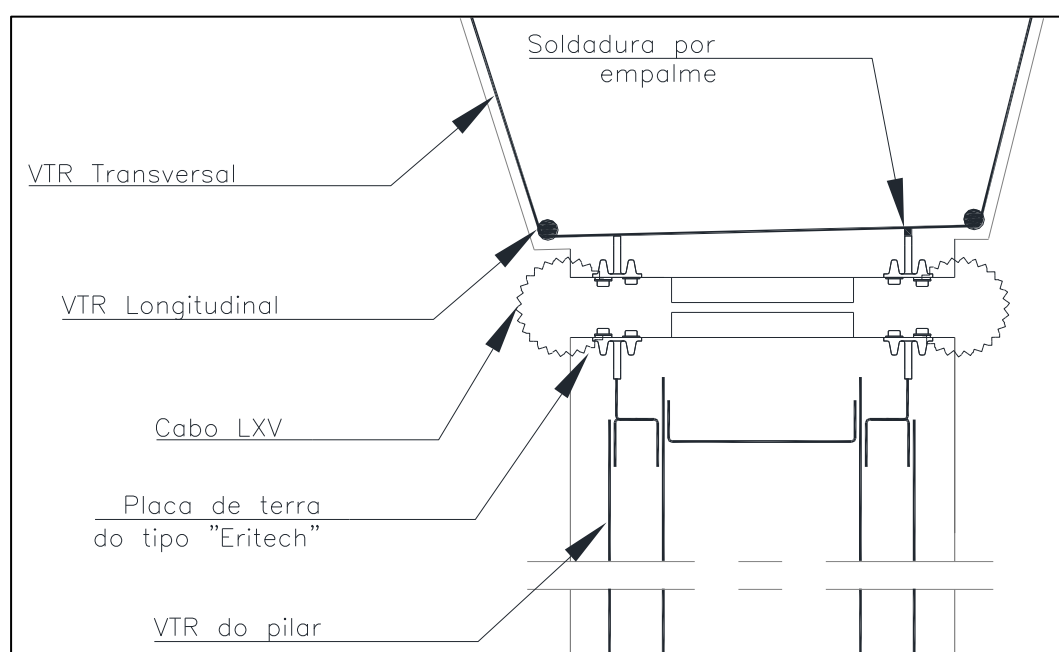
Desenho de princípio da ligação das armaduras dos pilares às armaduras do tabuleiro
